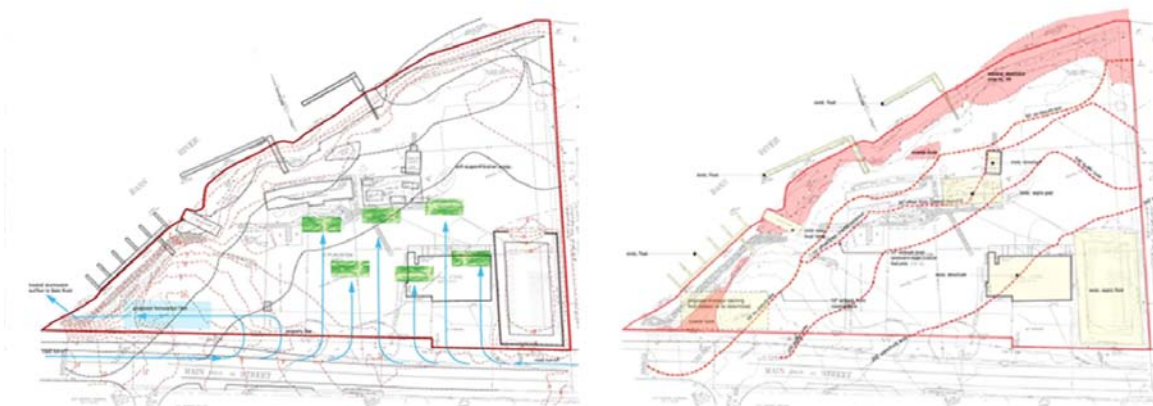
Bass River Park - Area di progetto, schema esondazione del fiume.
